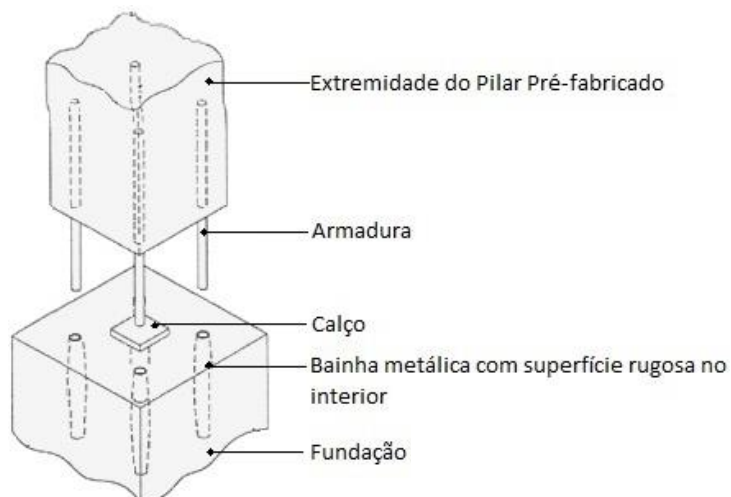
Ligação Pilar – Fundação com armaduras salientes no Pilar [46]
